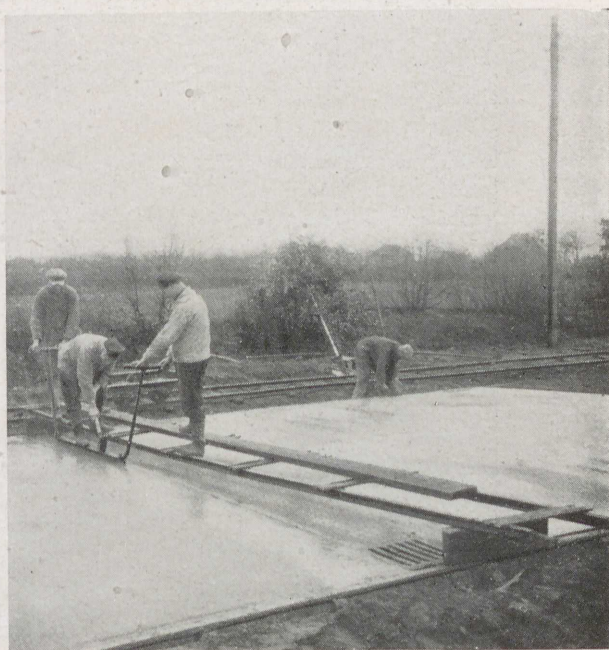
Betonstraße Höver. Fertige, jedoch noch nicht vergossene Fugen. Längsfuge zwischen Betonbahn und Straßenbahngleiskörper (Schlackensteine auf Beton)
